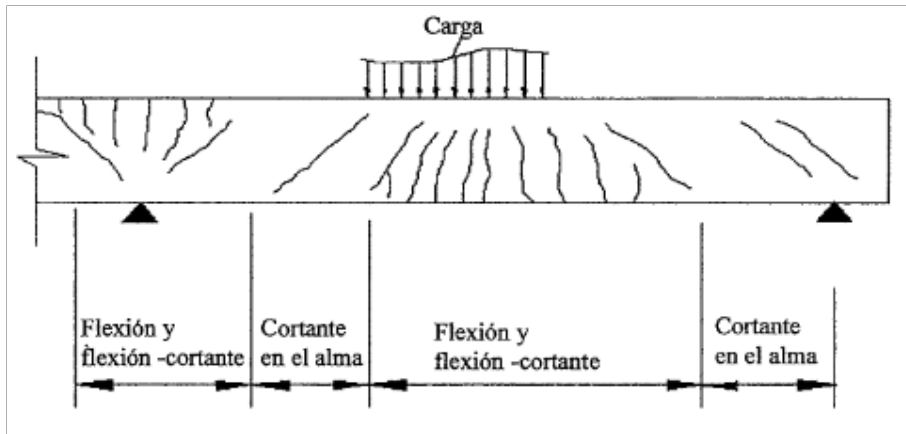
Tipos de agrietamiento en vigas de concreto armado (Ottazzi, 2015, p.323)
